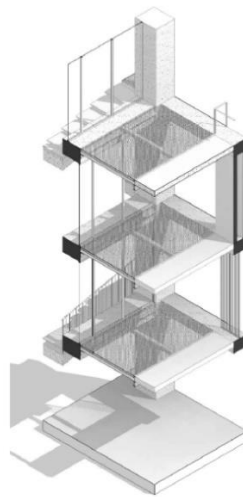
Detalle de pasarela. 2022 (Fuente Propia)
